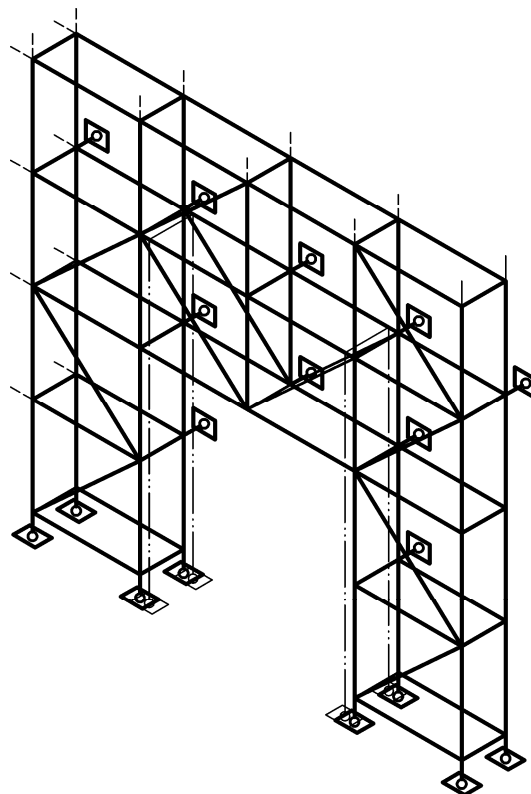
Überbrückung mit Stahlrohren für die Regelausführung der Stahlrohr-Kupplungsgerüste als Standgerüste mit längenorientierten Gerüstlagen
